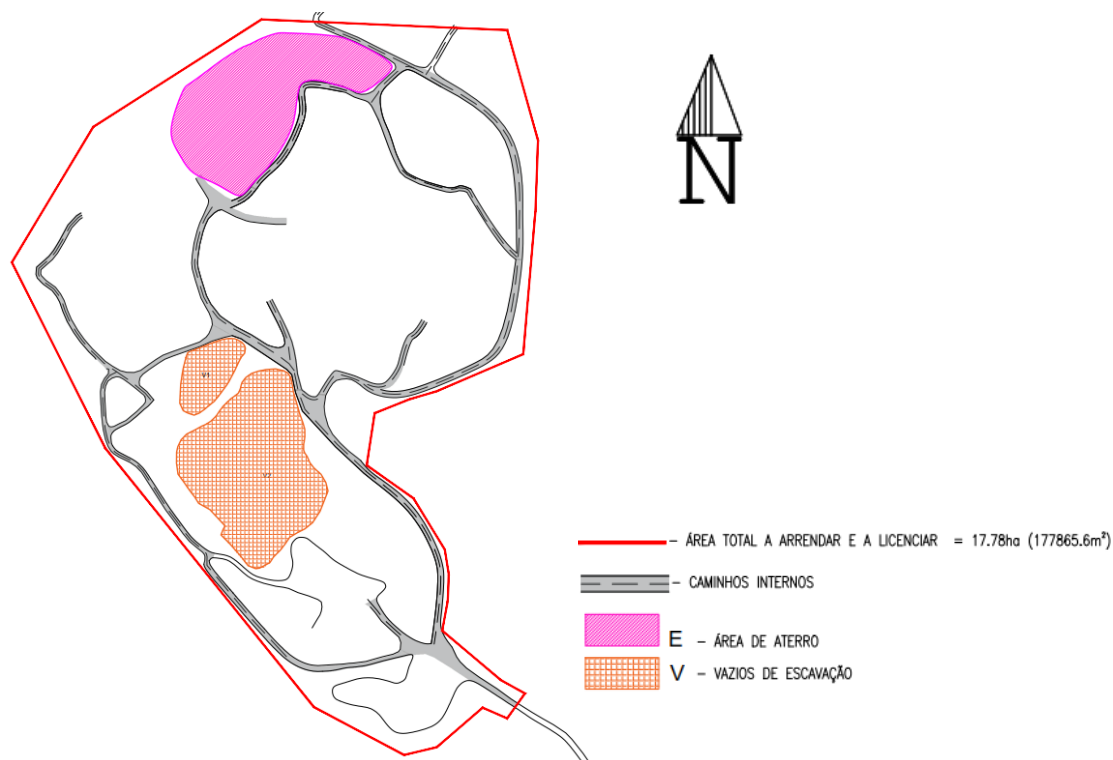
Localização, em planta dos caminhos de acesso ao aterro e aos vazios de escavação.
